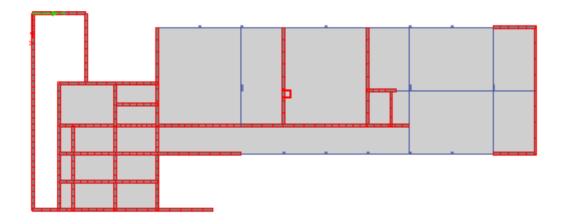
Planta Segundo piso, Bloque A Municipalidad.
